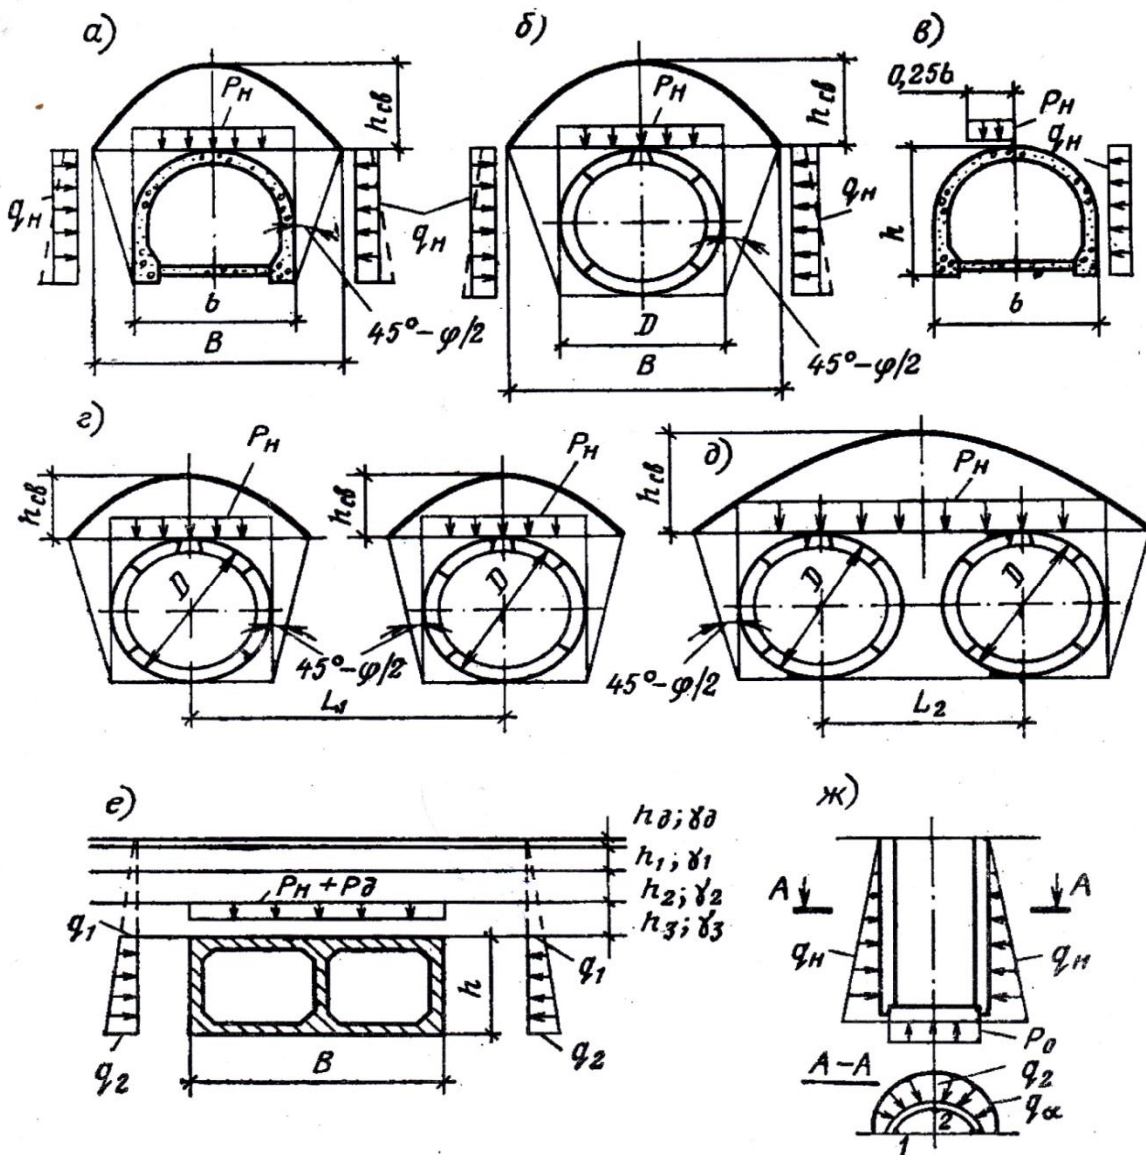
Схема определения давления грунта на конструкции подземных сооружений сводчатого (а, в), кругового (б, г, д, ж,) и прямоугольного (е) поперечного сечения
